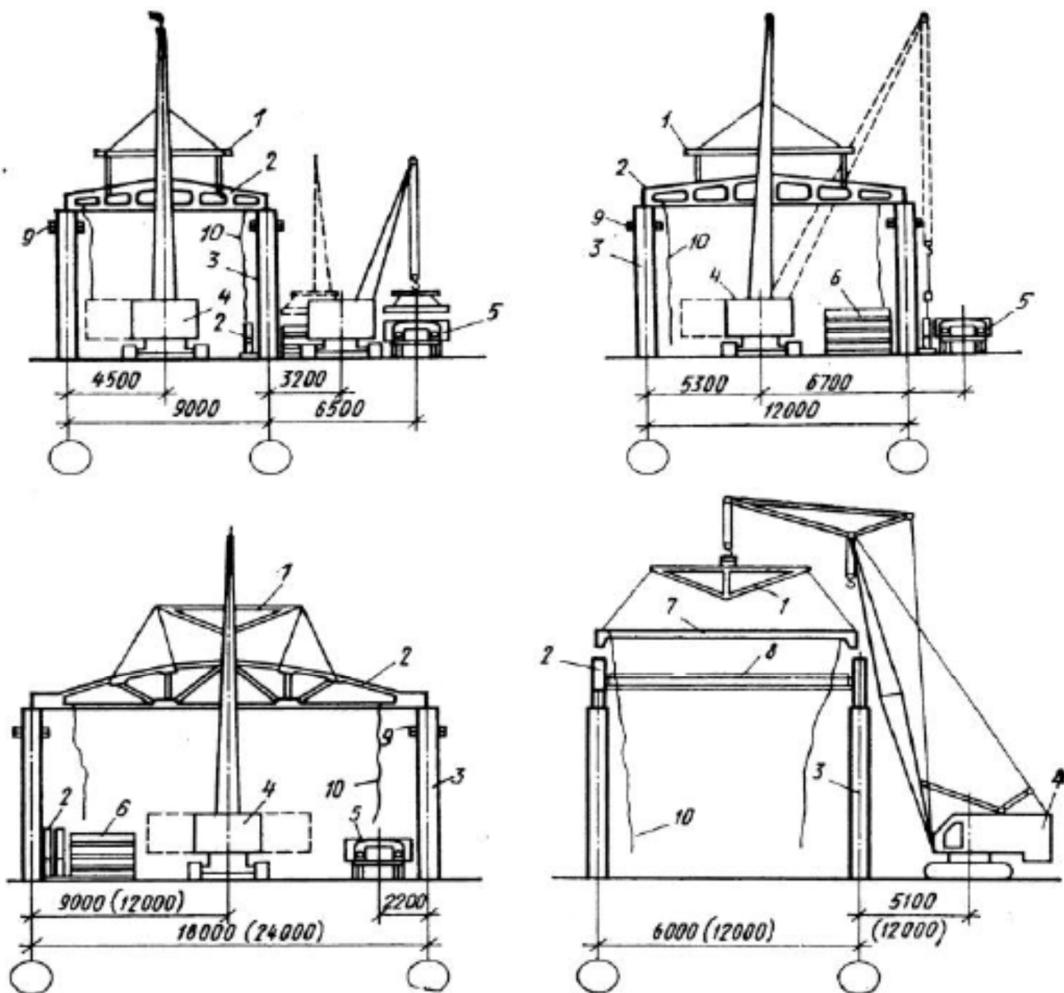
Схемы монтажа фермы пролетом 9, 12, 18 и 24 м и плиты покрытия продольным методом: 1 - траверса; 2 - стропильная ферма; 3 - колонна; 4 - кран; 5 - транспортное средство; 6 - штабель плит; 7 - монтируемая плита; 8 - временное ограждение; 9 - лестница-площадка; 10 - оттяжка.
